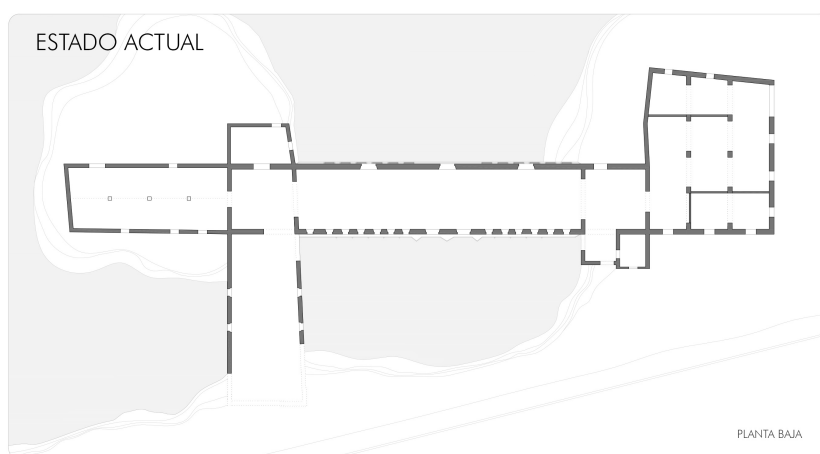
Estado actual. Planta baja (Machuca Macías, 2013).
